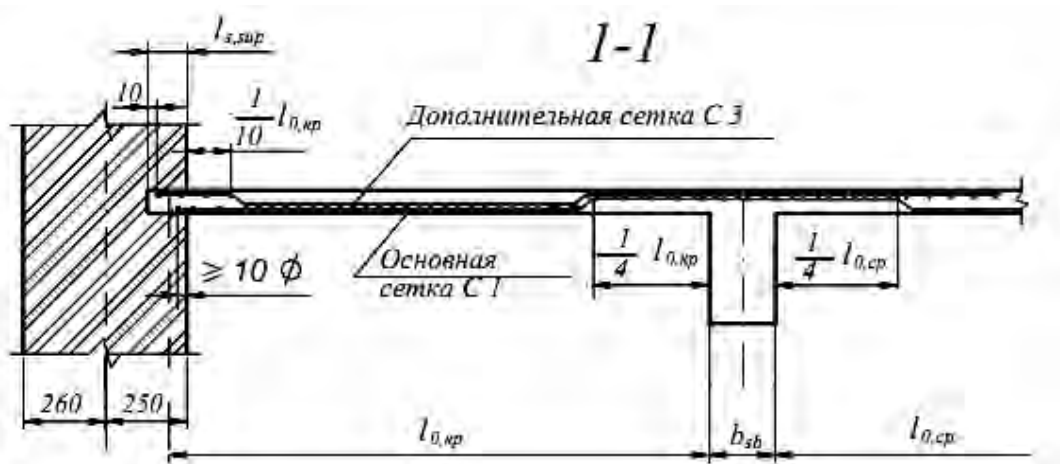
Непрерывное армирование монолитных неразрезных плит сварными рулонными сетками
